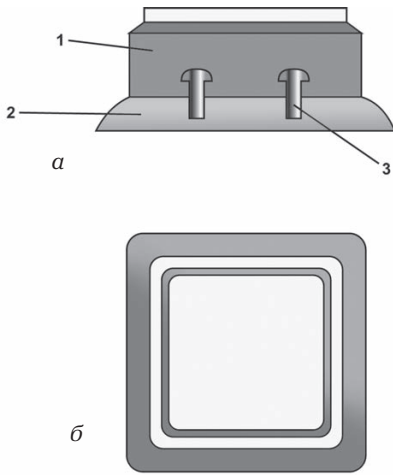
Установка открытого выключателя: а — вид сбоку в разрезе; б — вид сверху; 1 — корпус; 2 — подрозетник; 3 — шуруп
